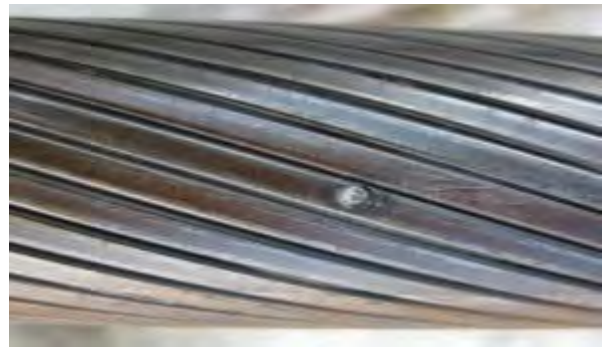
Faible défaut causé par la foudre sur un câble clos
